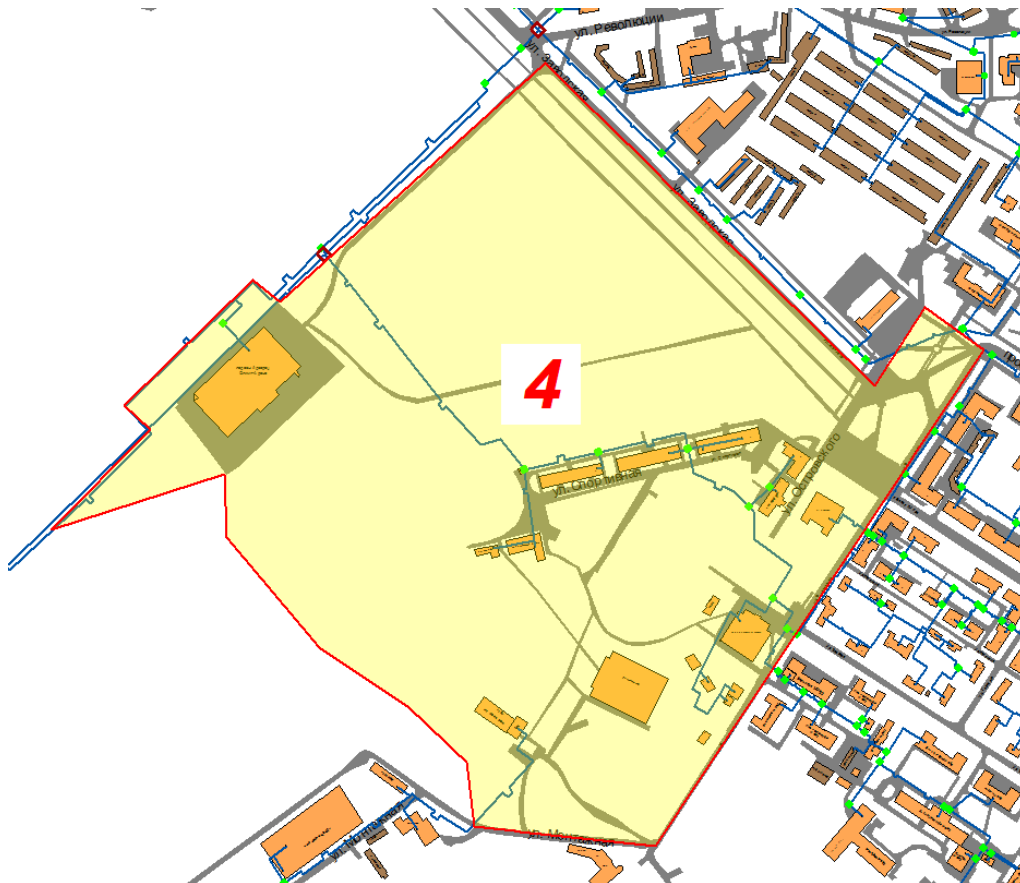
Схема расположения площадки № 4 и тепловых сетей
